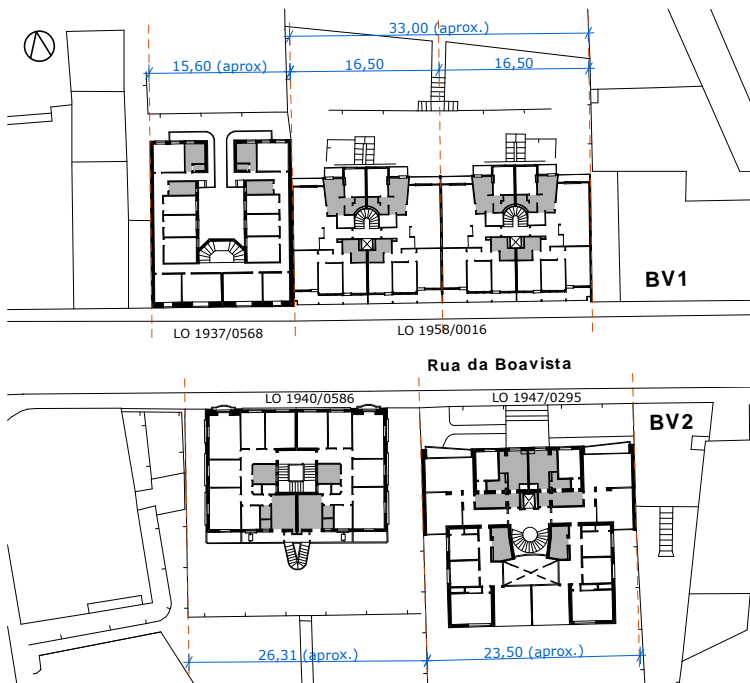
Sectores na Rua da Boavista. Plantas do piso-tipo. Esc. 1/750 (aprox.).
